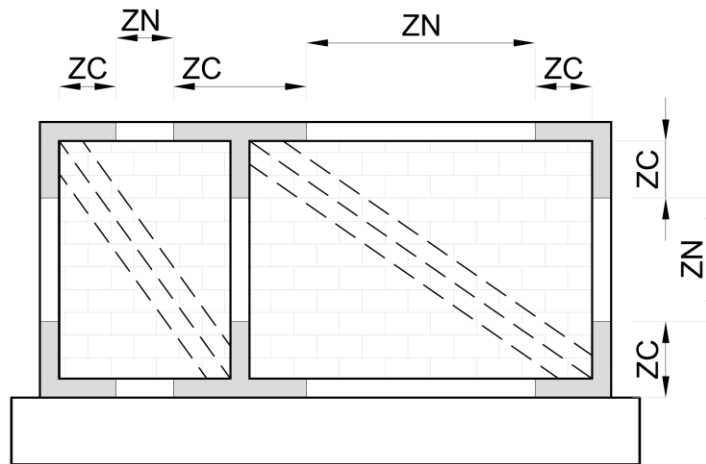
Zonas Normales y Zonas Críticas para la armadura transversal
